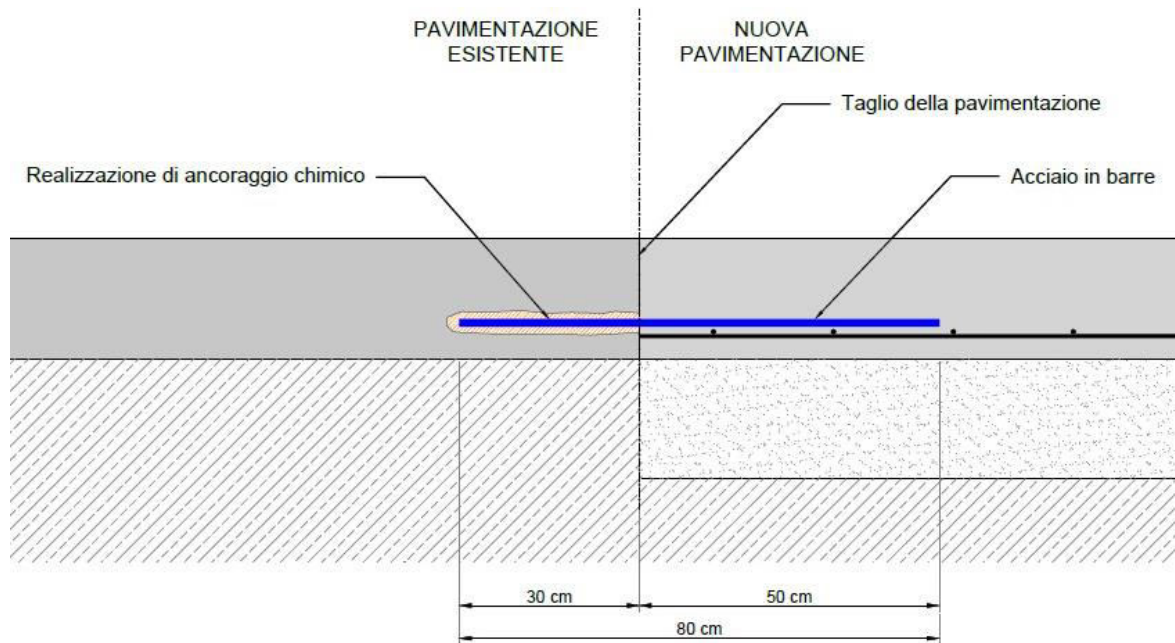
Raccordo tra pavimentazione industriale esistente e nuova (particolare Tipologico "B")
